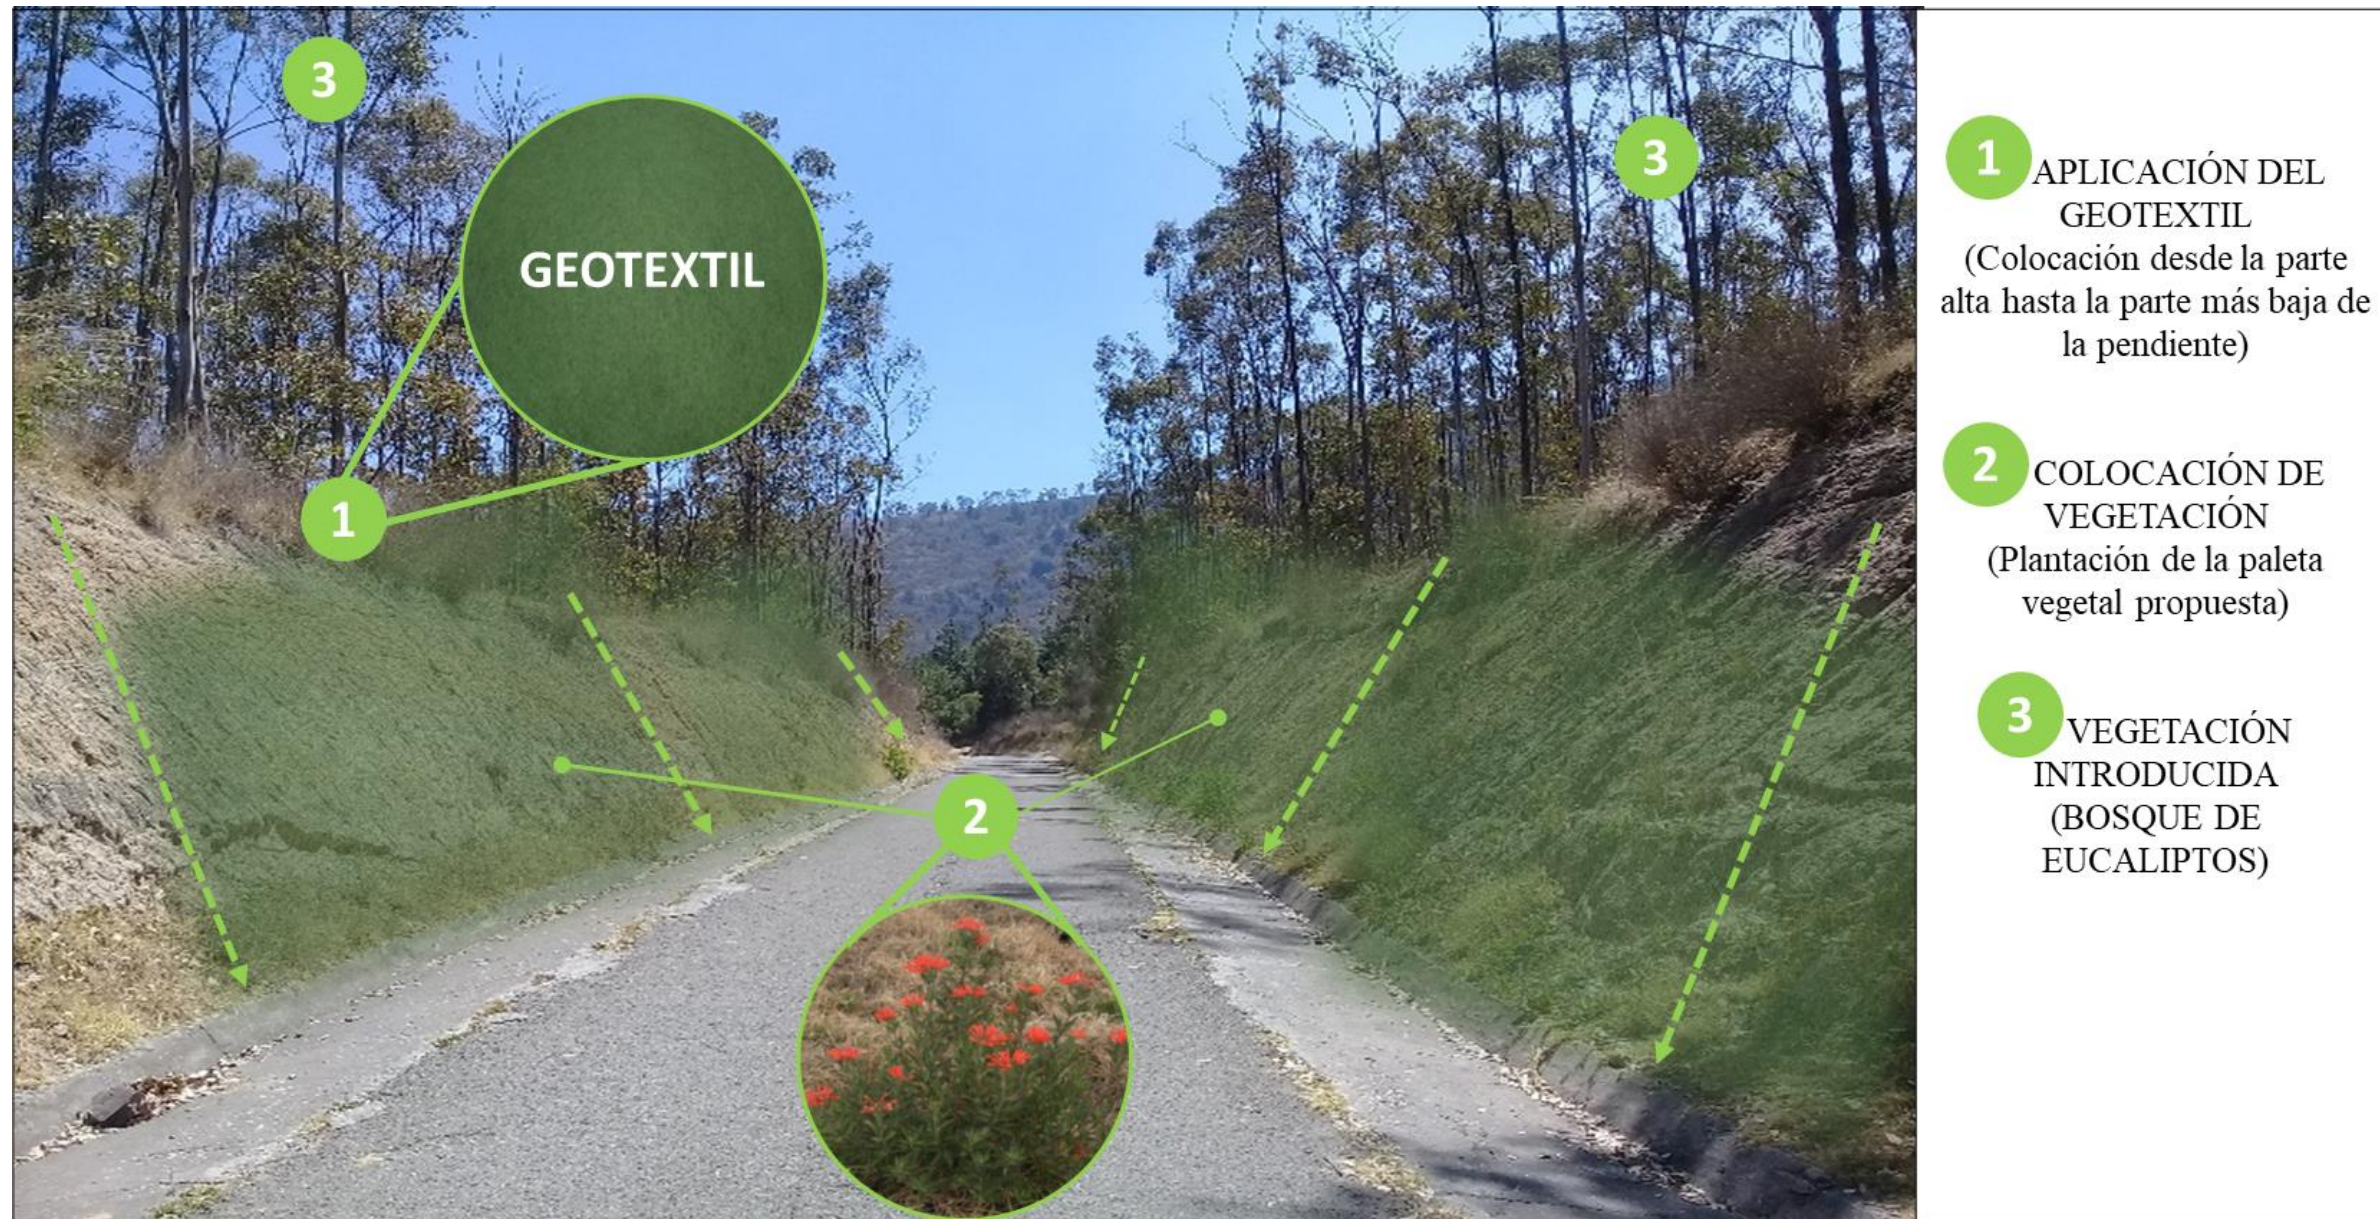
PLANO DE PLANTACIÓN DEL GEOTEXTIL PARA EL SECTOR "B". Fuente: creación propia.
